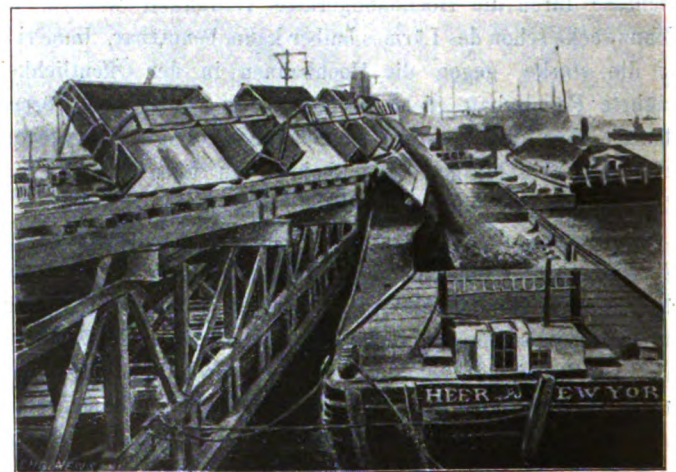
Baustelle der IV. Avenue-Untergrundbahn in Brooklyn, südlich der 7. Straße.
